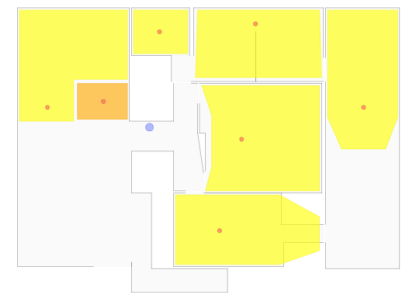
Grundriss vom Erdgeschoss
